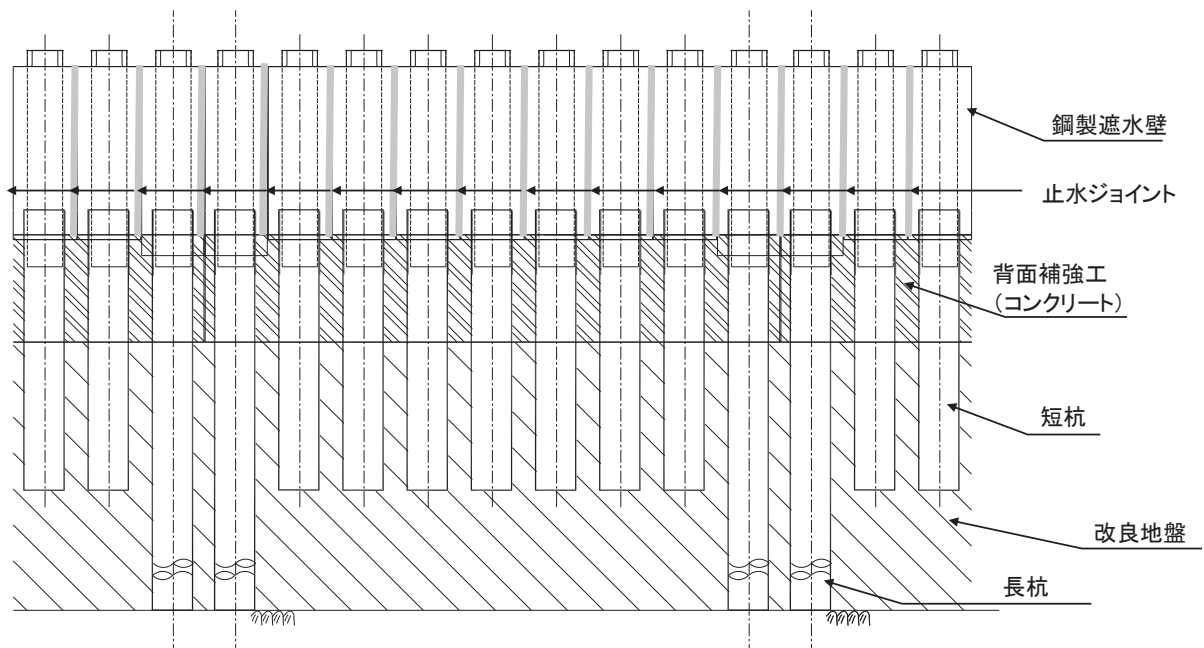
鋼管式鉛直壁（一般部） 正面図
